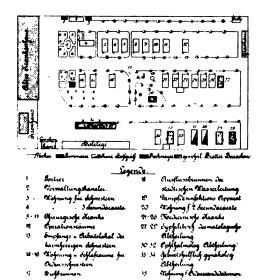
Baracken-Notspital in Laibach (Lageplan).
